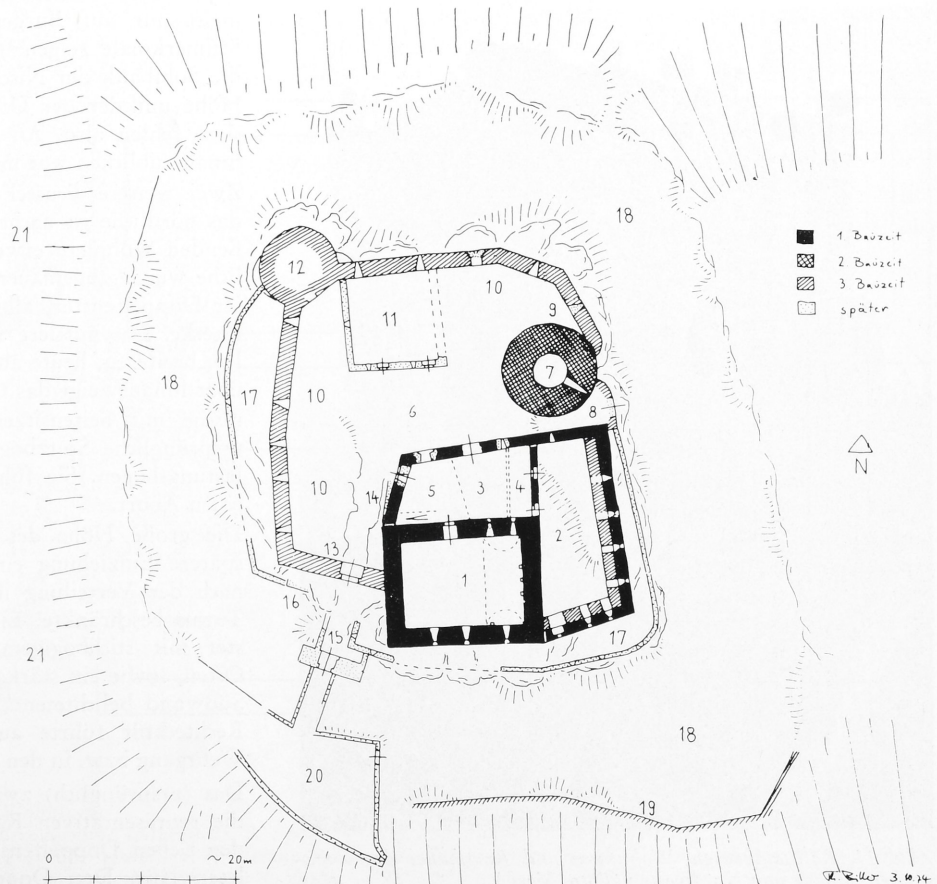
Rathsambausen, Grundriß jeweils in Erdgeschoßhöhe mit Bau-phasen
